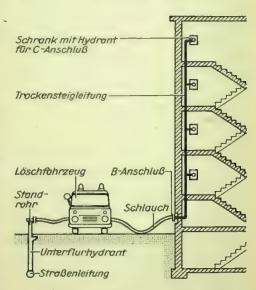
Trockene Feuerlösch-Steigleitung mit Hausanschluß für B-Rohr (70 mm Durchmesser) und Geschoßanschlüssen für C-Rohr (52 mm)
